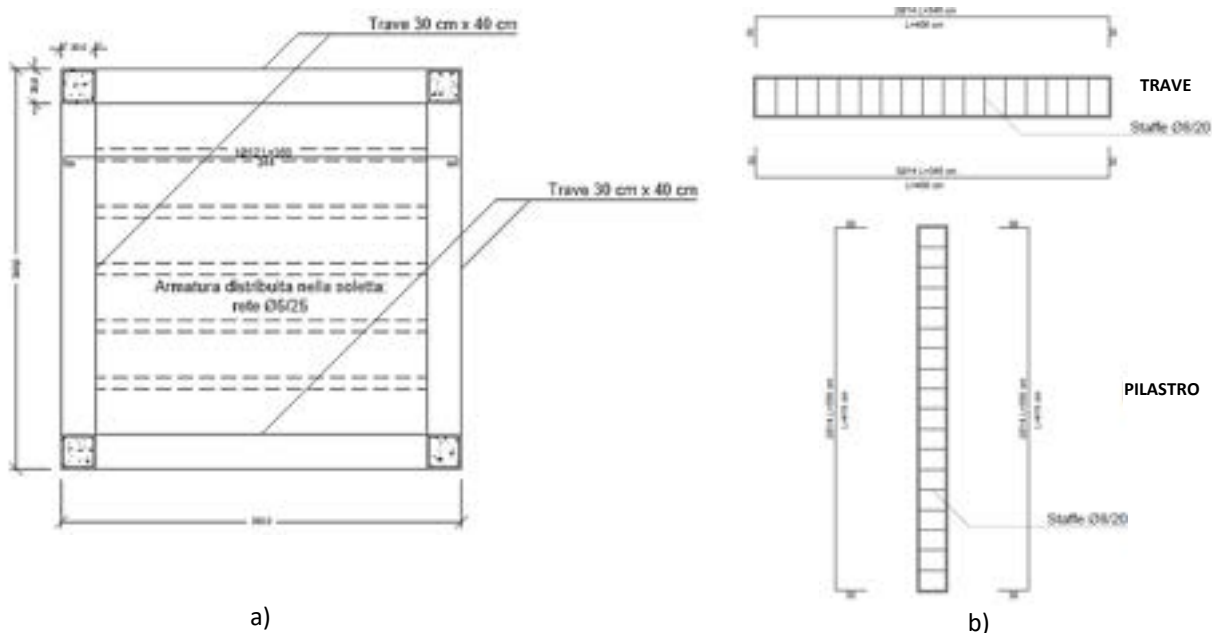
Elementi di primo dimensionamento: a) Carpenteria solaio; b) Distinta armatura travi e pilastri
